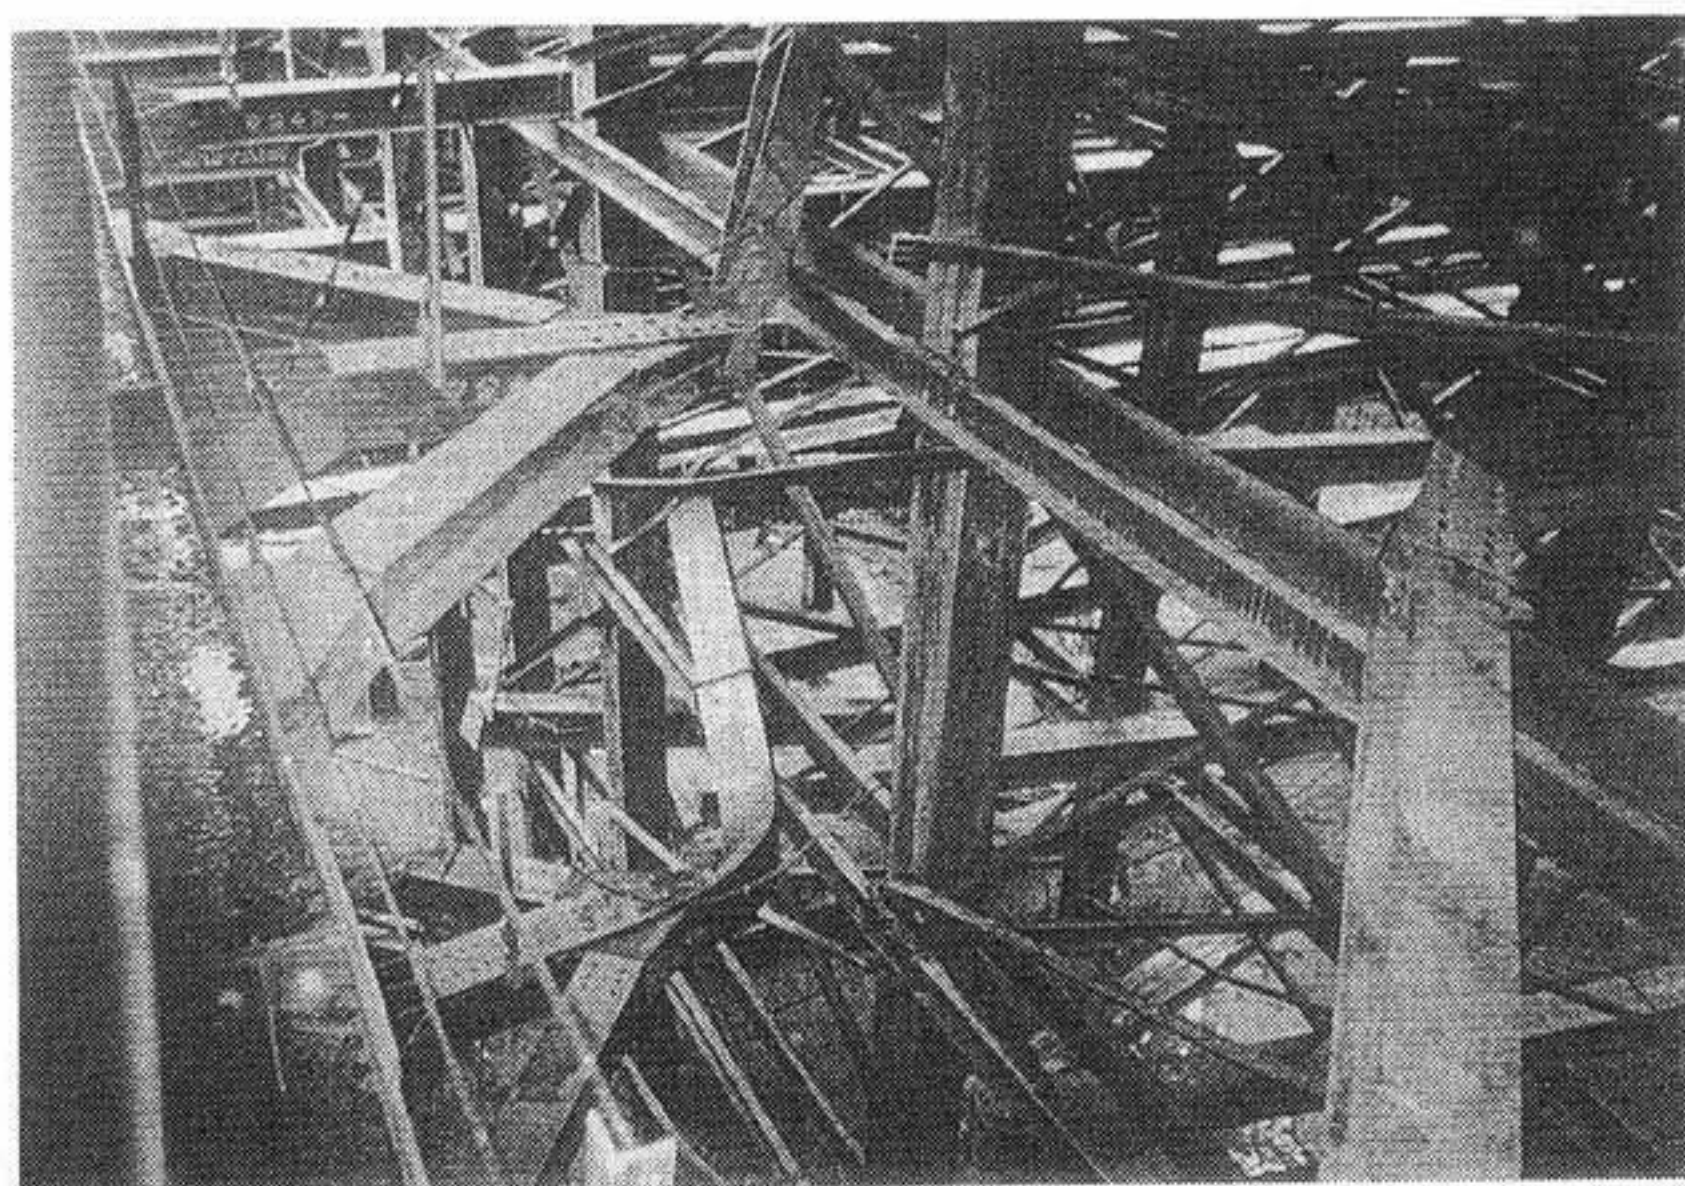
法面部の切梁の崩壊状況（その1）
